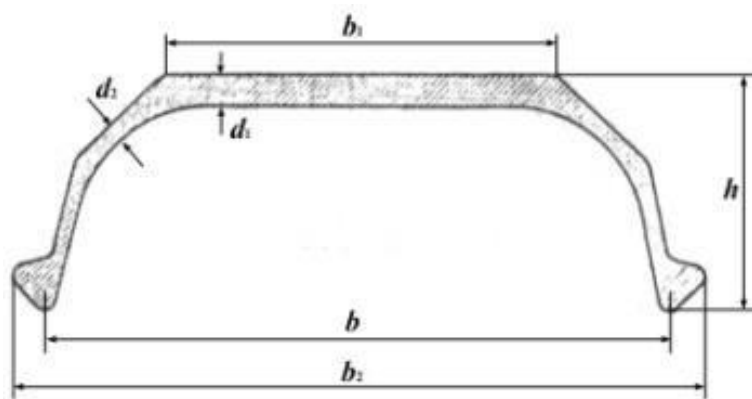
SECCIÓN LONGITUDINAL Y PLANTA DE UN DURMIENTE METÁLICO
